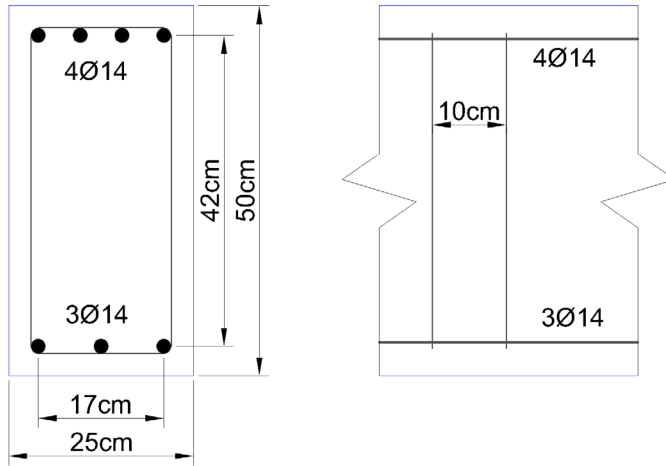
Betonarme kolonun en kesit boyutları ve donatı yerleşim detayı
